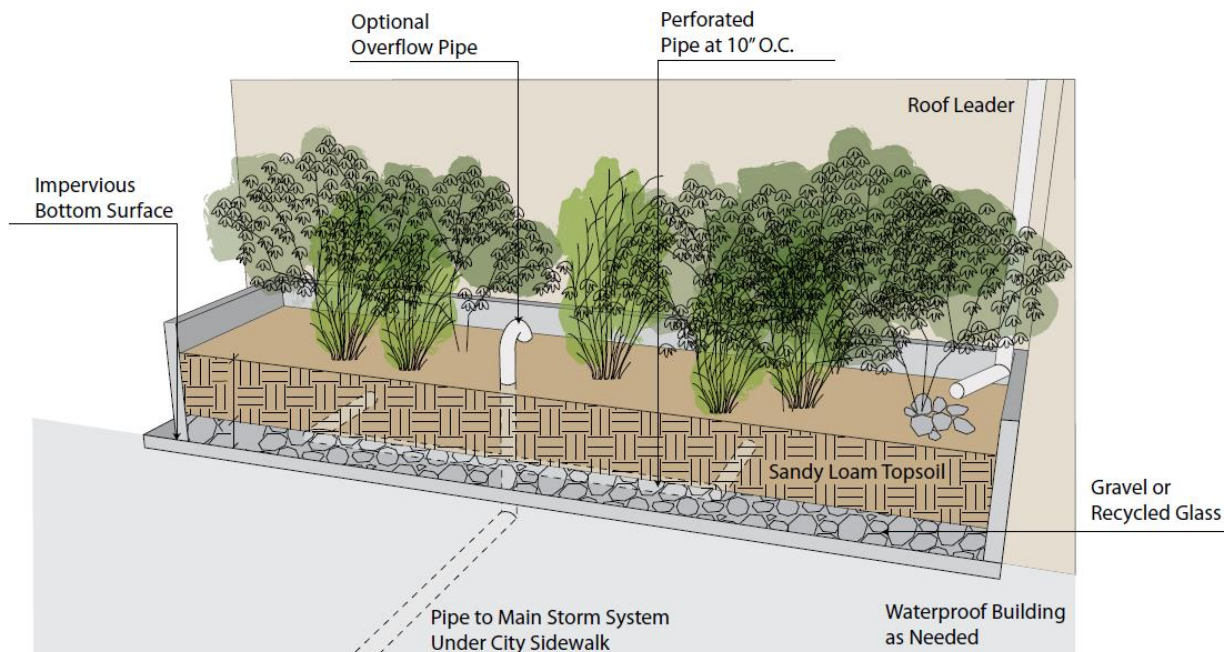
Principais componentes de um sistema de biorretenção (NYC Department of Design and Construction, 2008)
